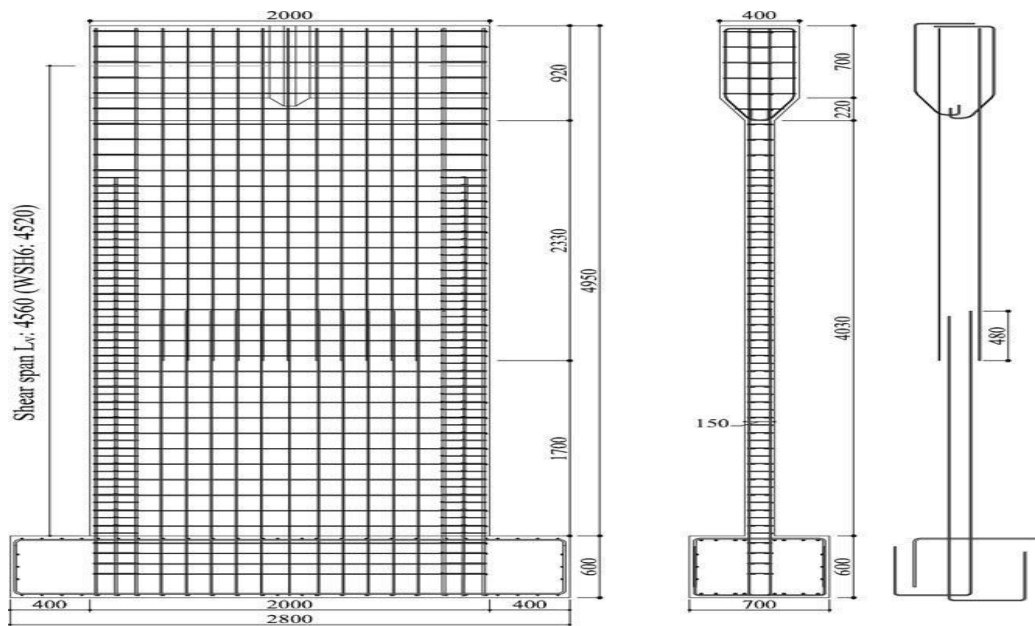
Disposition des armatures verticales de voile 03 (toutes les dimensions en (mm))
